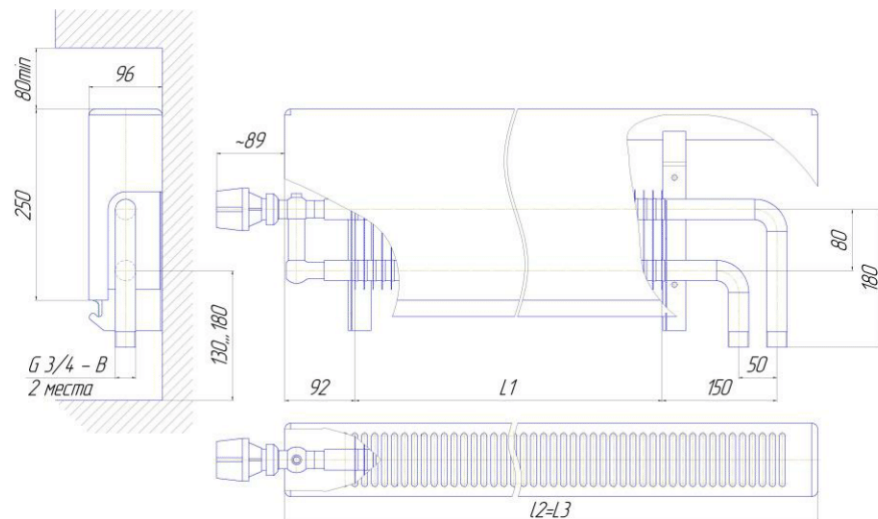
Конвектор ТЗПО «Универсал ТБ-Мини» (К; Резьба; Прав; А2(юб); НП)
